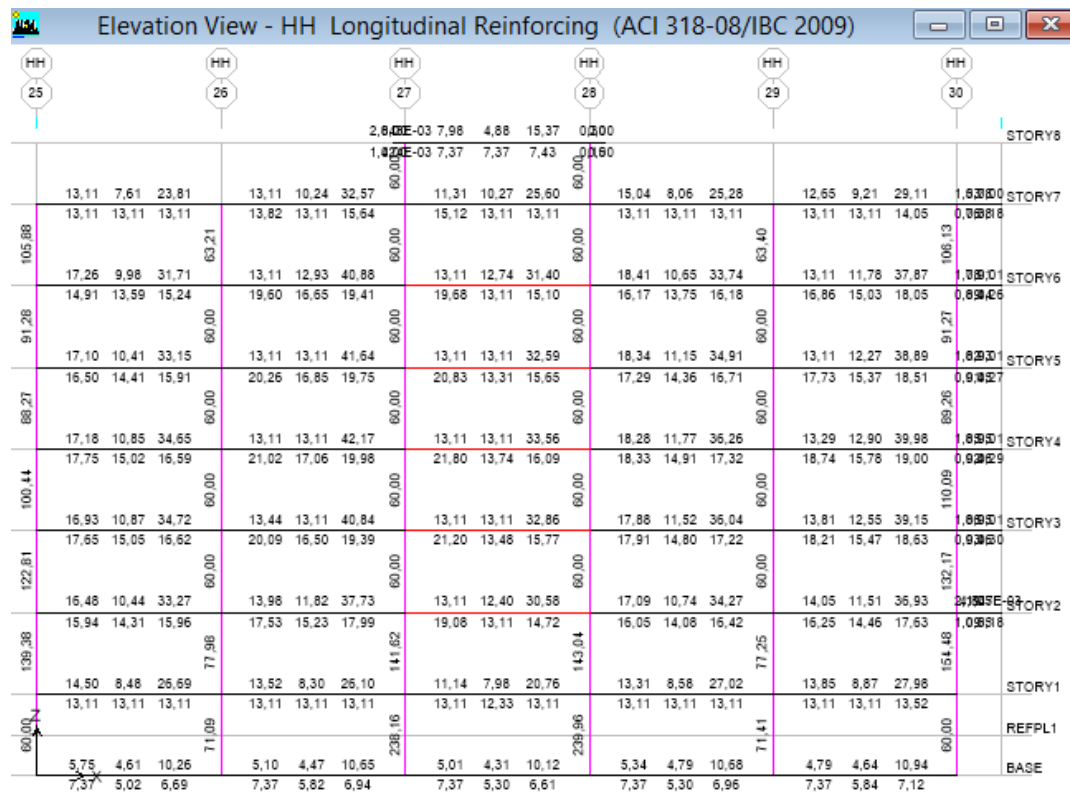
Acero en Vigas y Columnas en el Pórtico HH – Hospitalización 2- (LRB+HDR)
